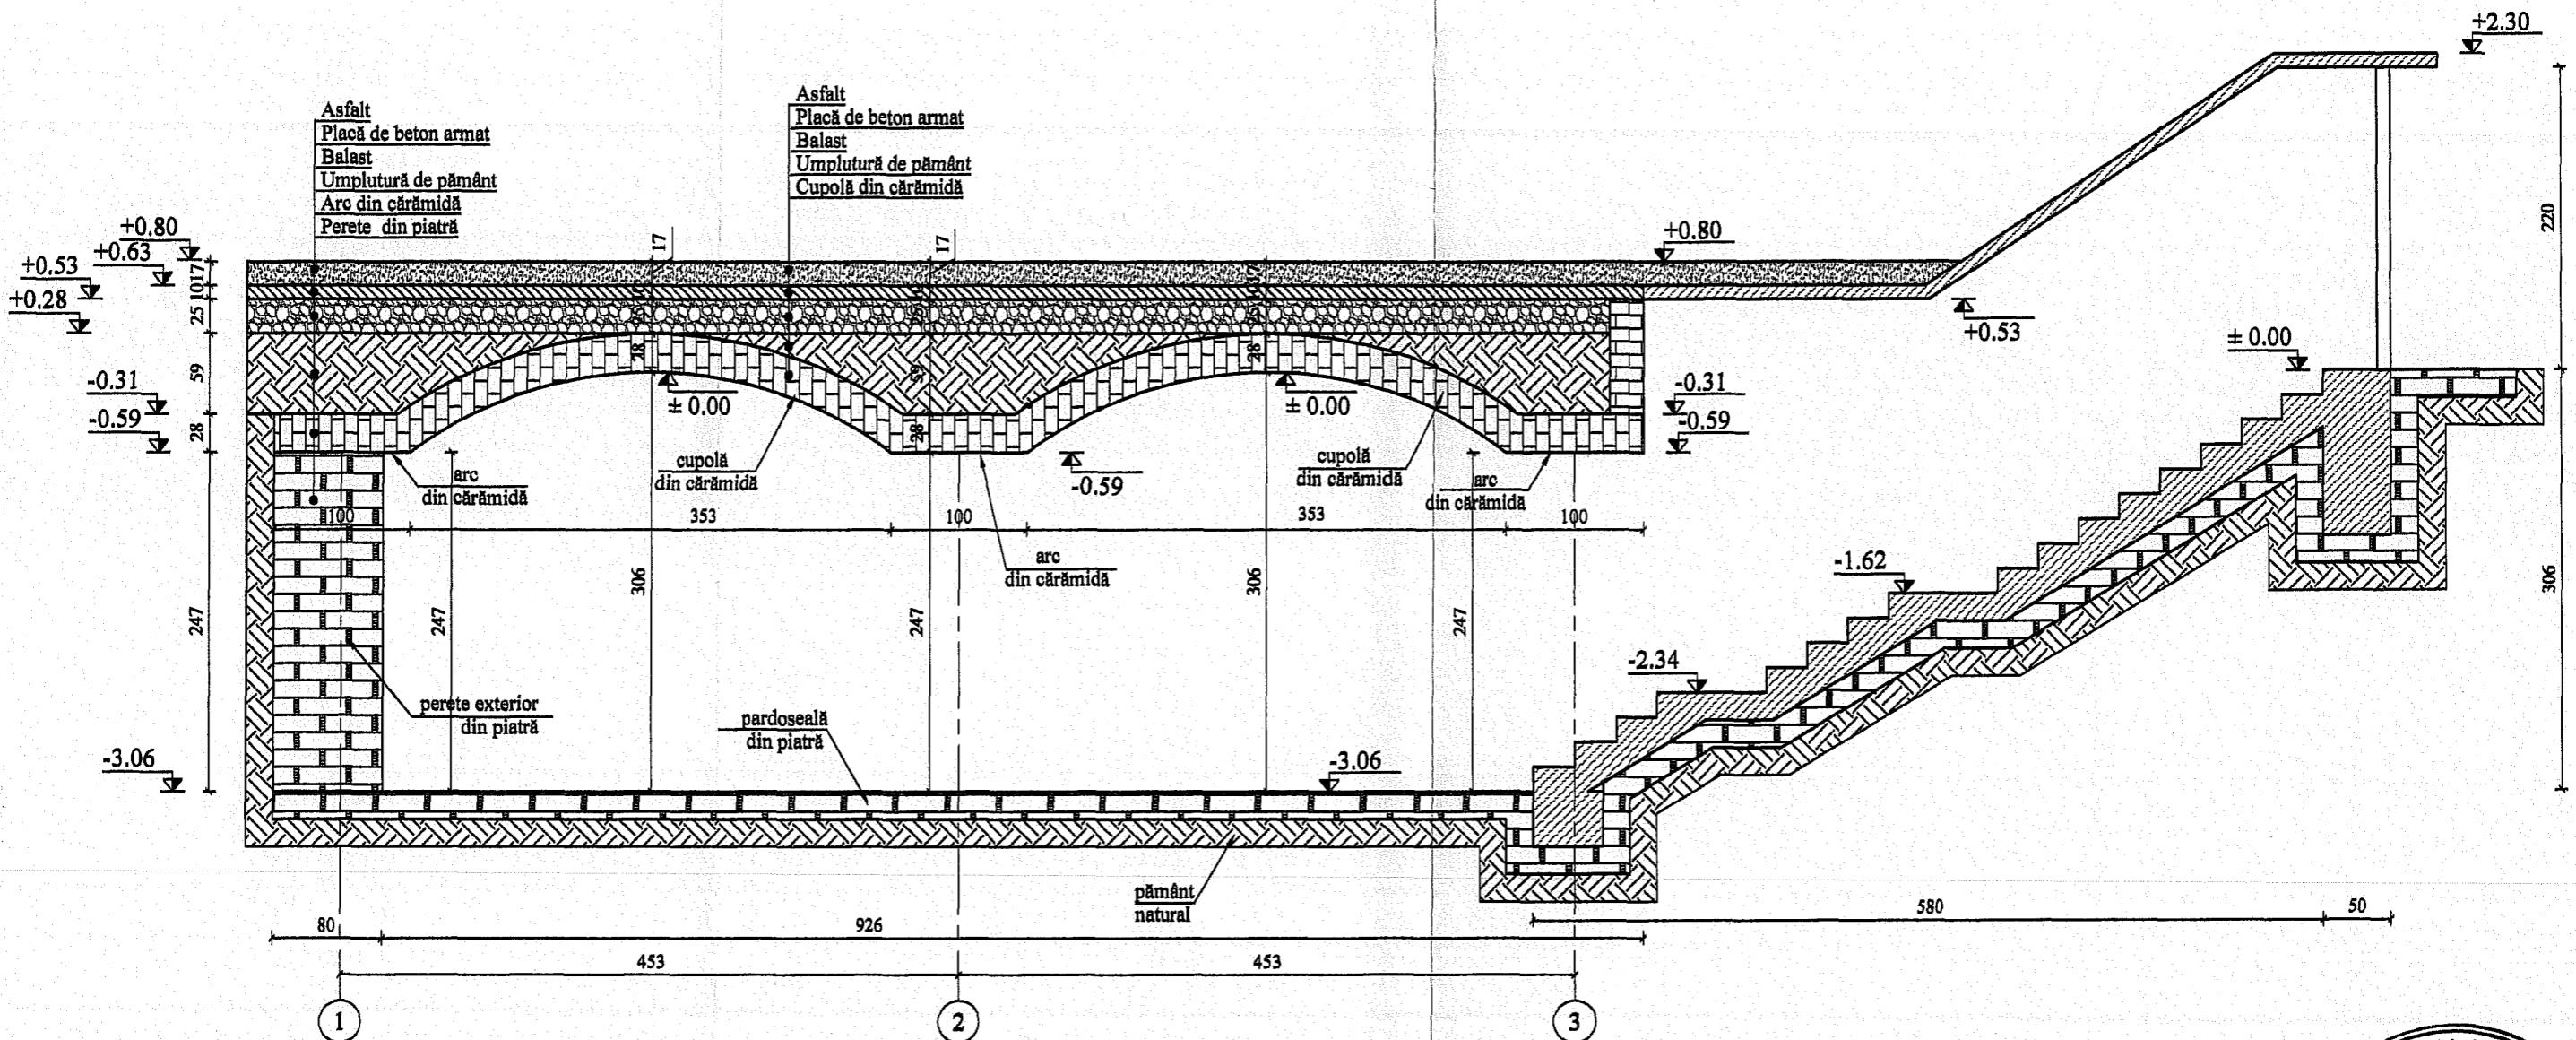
SECȚIUNE TRANSVERSALĂ A-A - SITUAȚIE EXISTENTĂ
